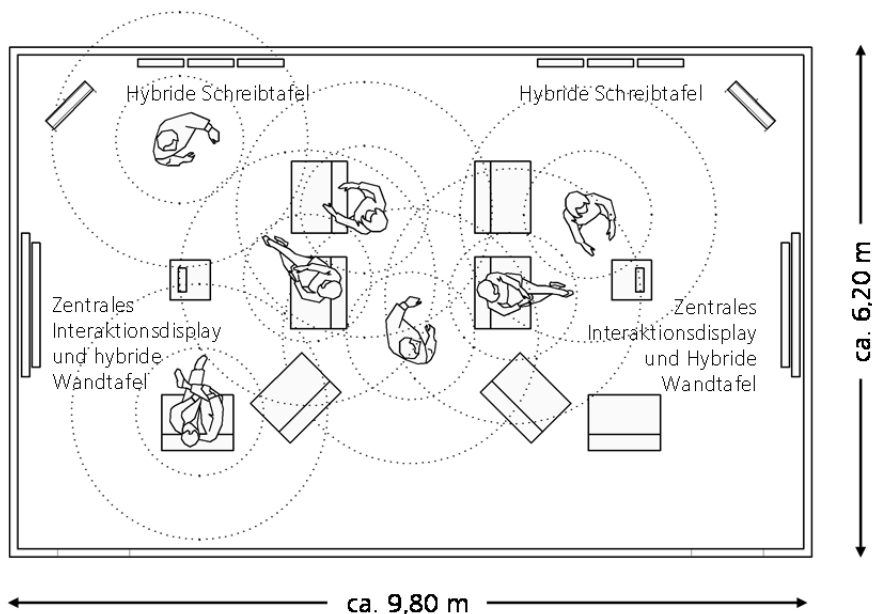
Modul 3 (Create), Kleingruppensituation, Grundrissdarstellung
